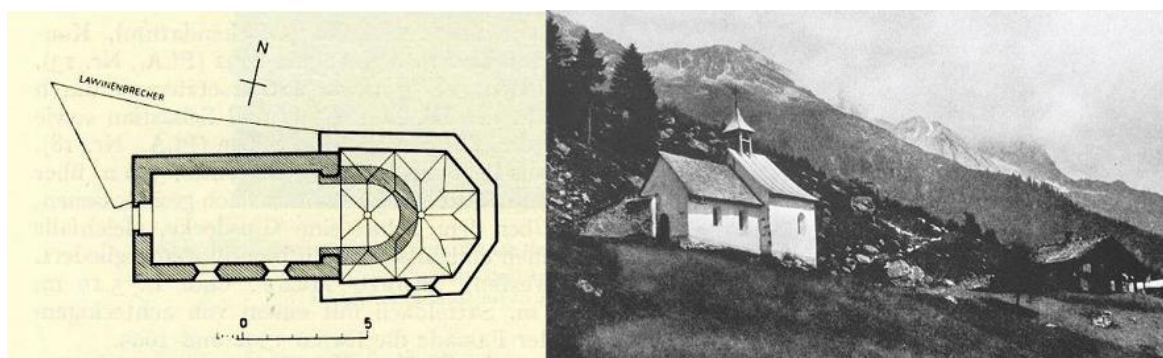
Capela Sogn Benedetg: planta baixa e aspecto em 1920.
